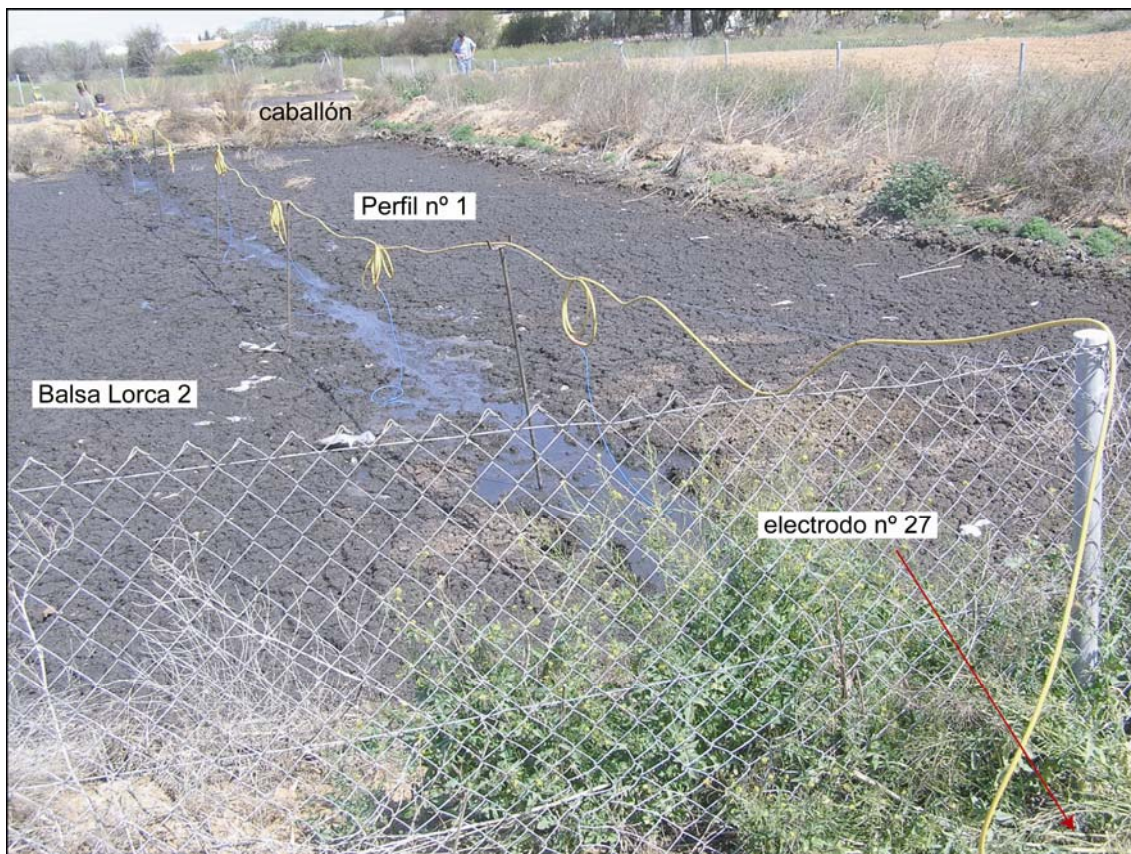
56. Vista parcial del perfil nº 1 listo para medir.
